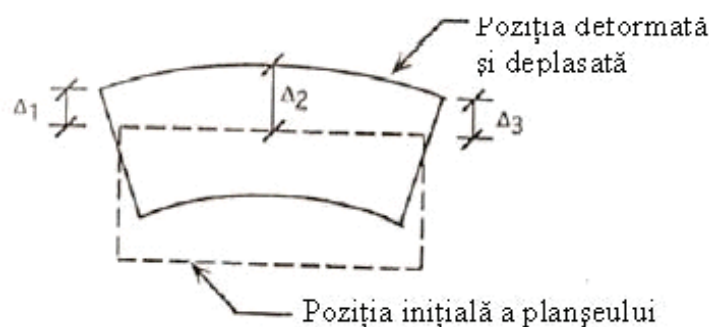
Definirea planșeelor flexibile în plan orizontal conform relației (C.21)
